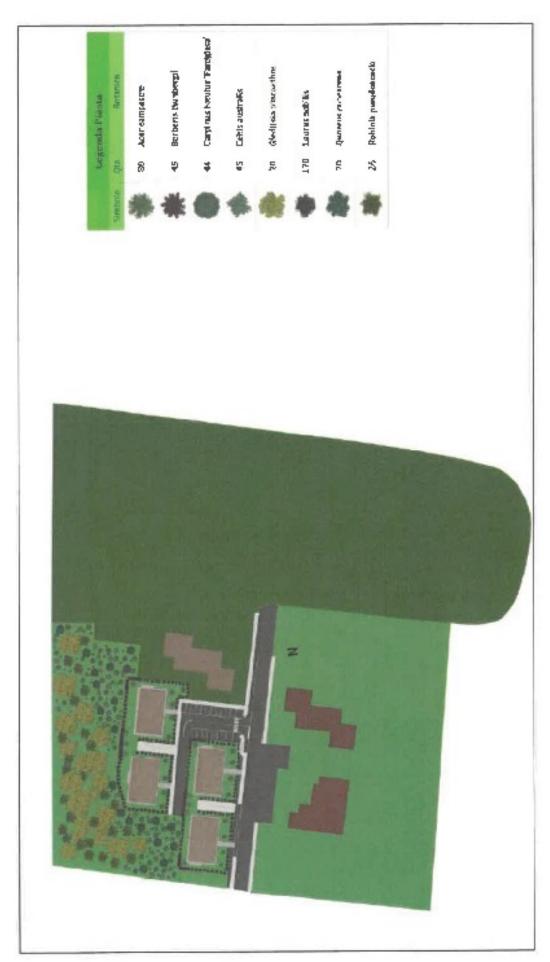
Planimetria di un esempio di inserimento degli edifici (schematico) e del vende esistente e di nuova piantumazione.
